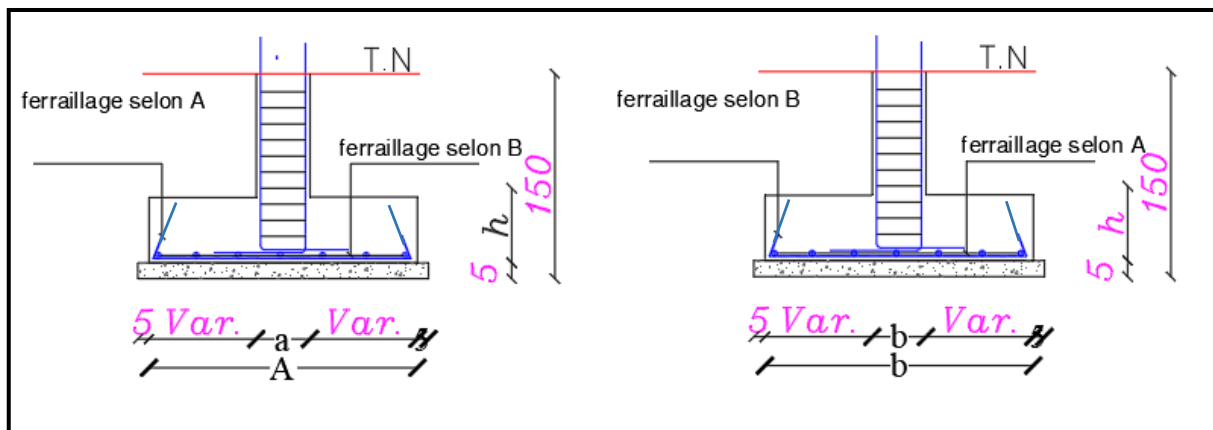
Exemple schéma de ferrailage de semelle isolée
